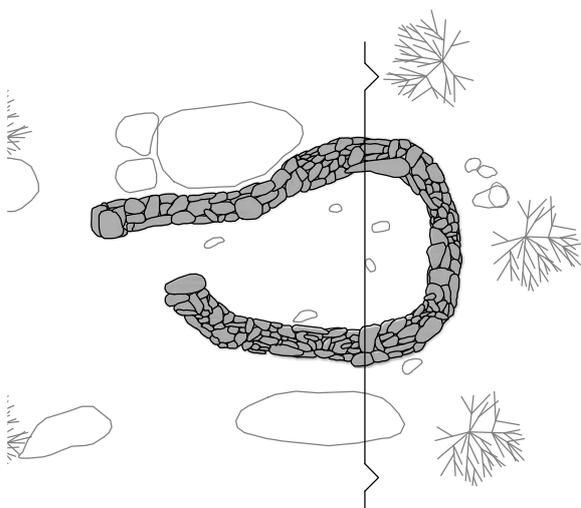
Planta del casal de las Olvidas en Bermillo de Sayago. Fuente: Elaboración propia.
